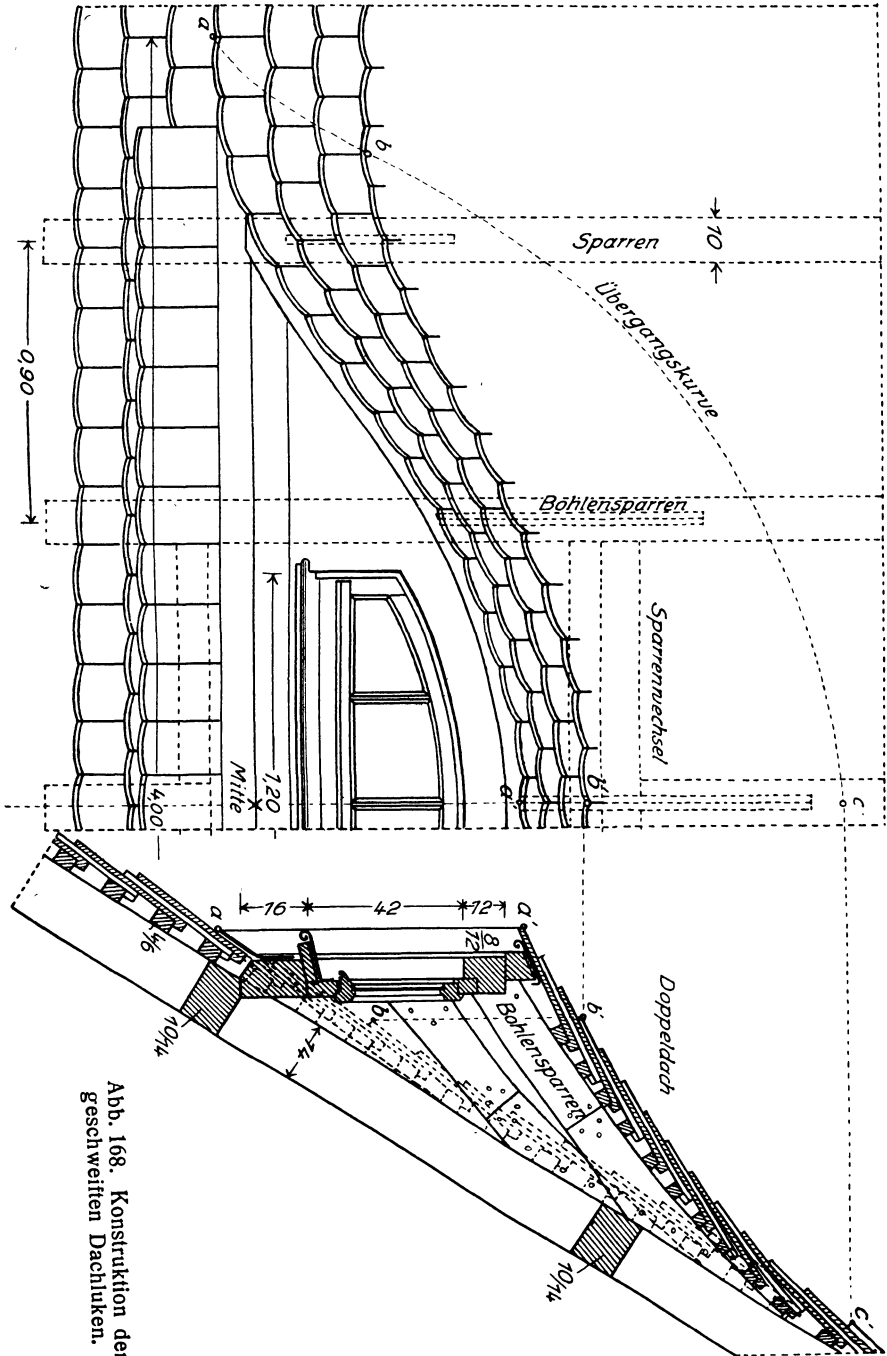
Konstruktion der geschweiften Dachlaken.
